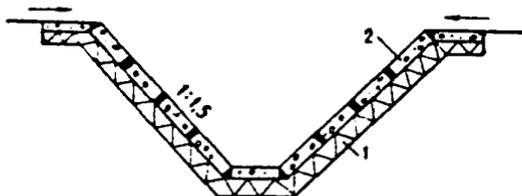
Конструкция водоотводного лотка с теплоизоляцией, укрепленного сборными кирпичными или железобетонными плитками:
